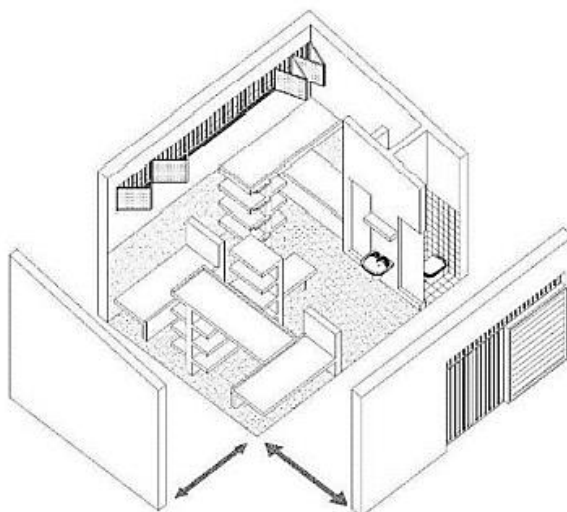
Planta Baixa Dormitório – APAC Santa Luzia
